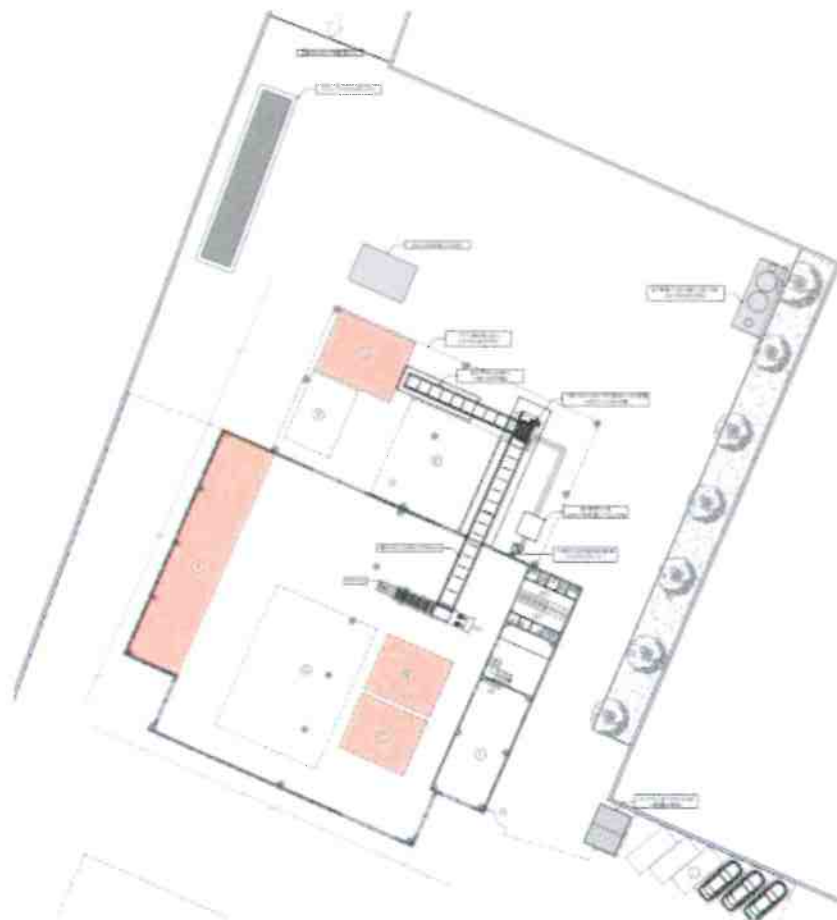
Stralcio del layout dell'impianto (da elaborato D allegato allo SPA)
